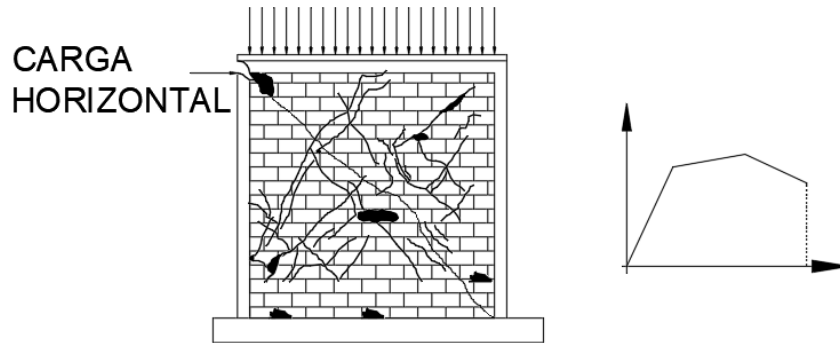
Daño estructural: Falla del muro [Flores & Alcocer, (2001)].
